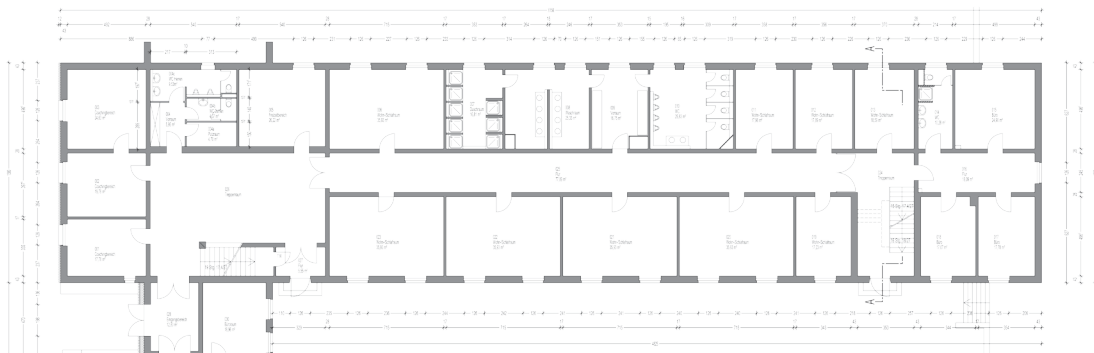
Bestand Grundriss Erdgeschoss
